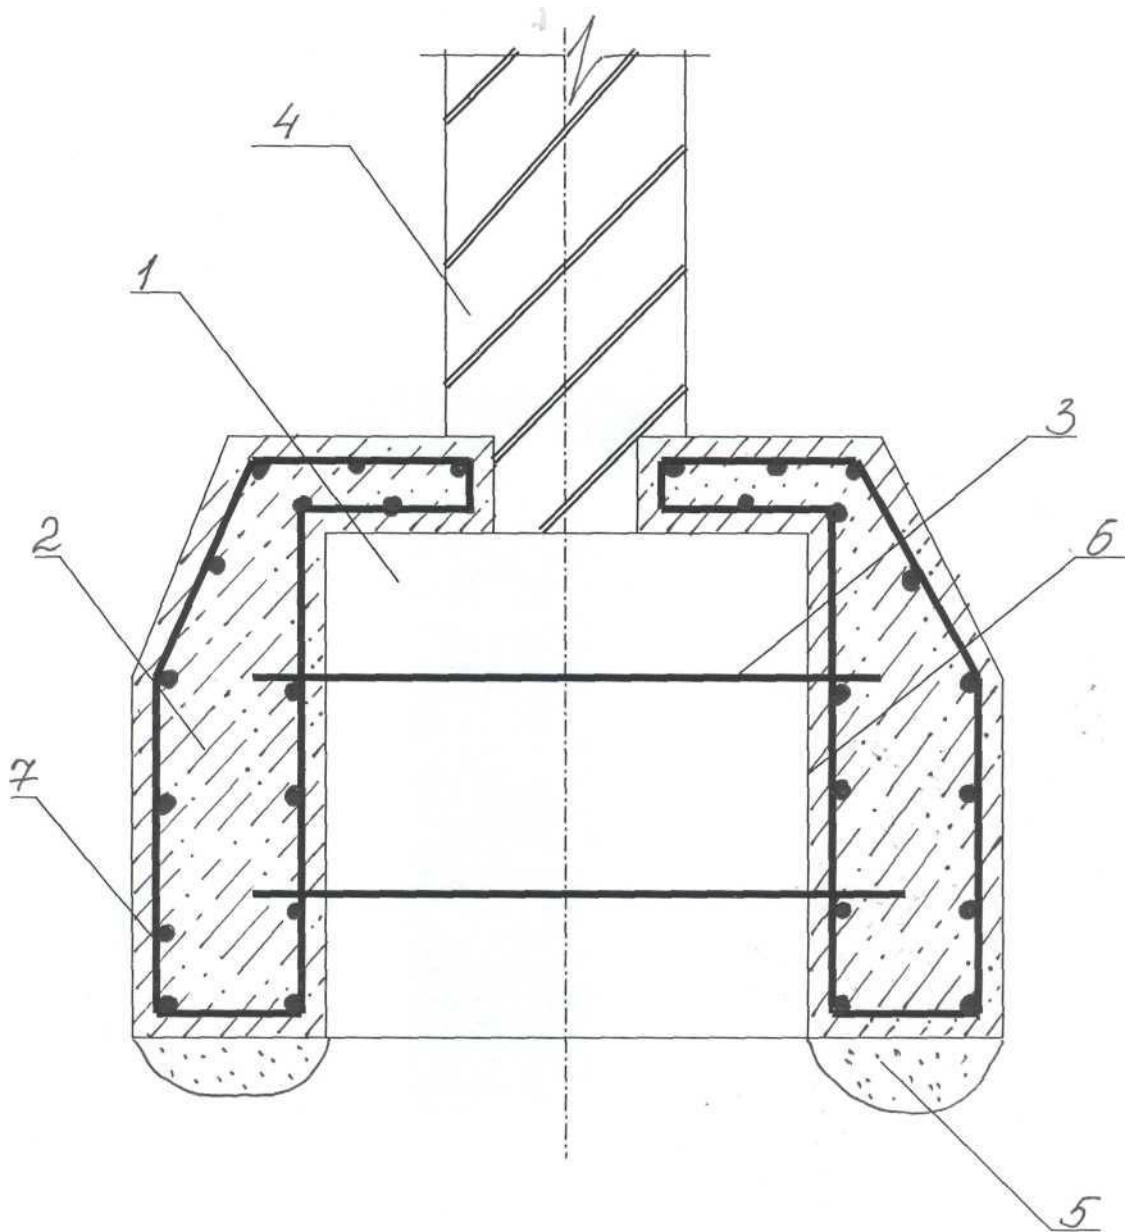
Уширение опорной площади и закрепление бутовой (бетонной, кирпичной) кладки устройством железобетонной обоймы
